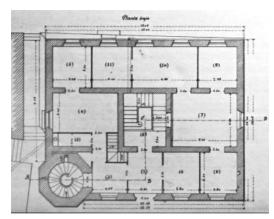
Planta baja del proyecto del ingeniero F. Pérez Alonso. 1894
